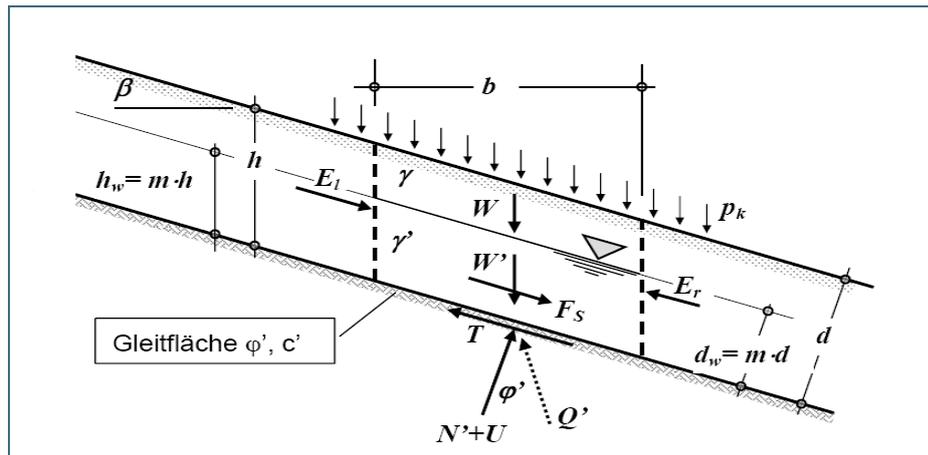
Beanspruchung beim Sonderlastfall hangparalleles Gleiten [3]
